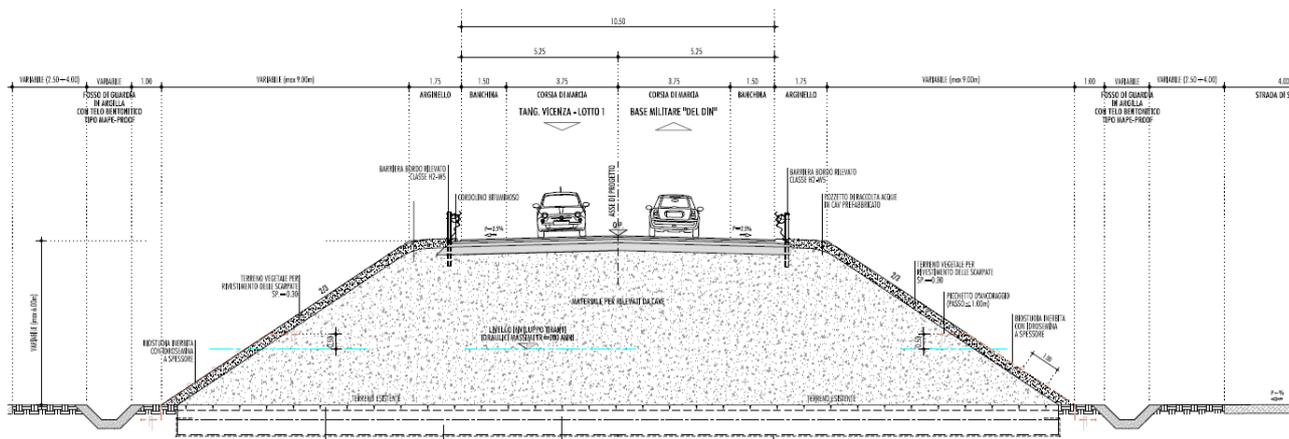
SEZIONE TIPO IN RILEVATO
